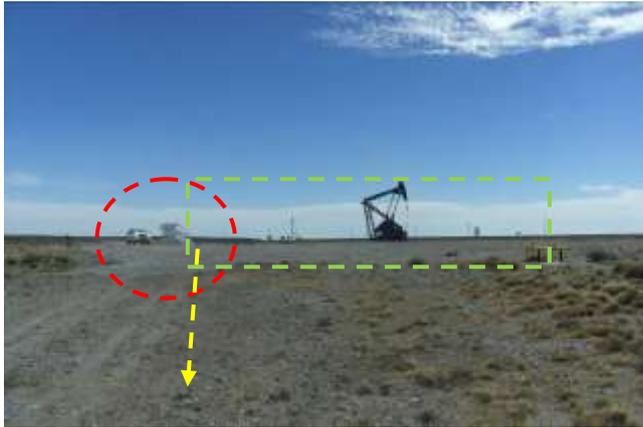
Emplazamiento de gasoducto por locación del Pozo AEN-402 (verde). Se observa Colector Auxiliar N° 1 EN II (rojo). Foto en dirección O.
